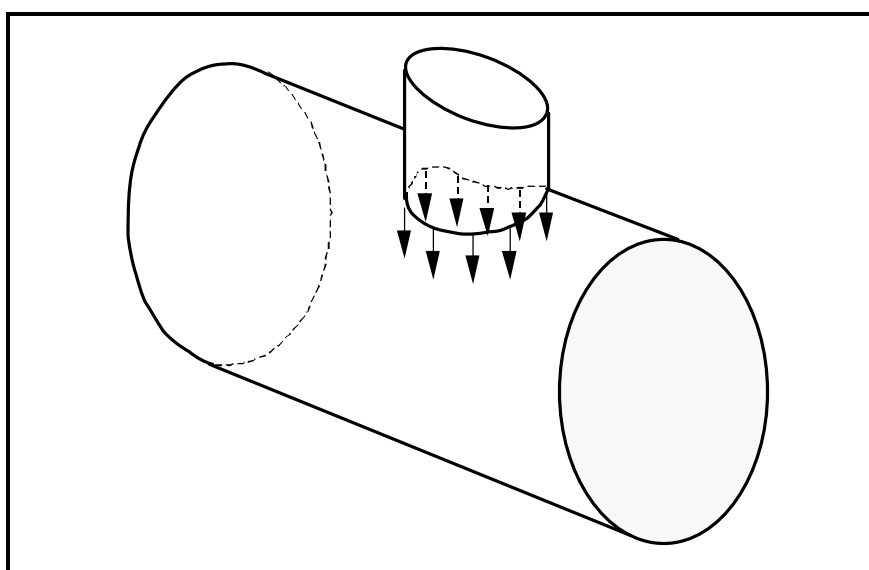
Exemplo de Falha em Juntas Soldadas.
